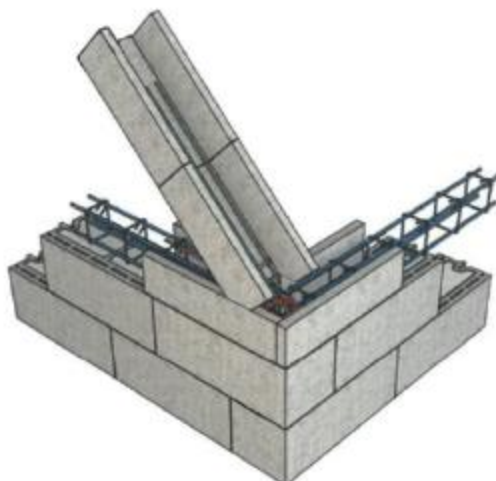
Zone non sismique, planelle isolée ou non d'une épaisseur > 50 mm
